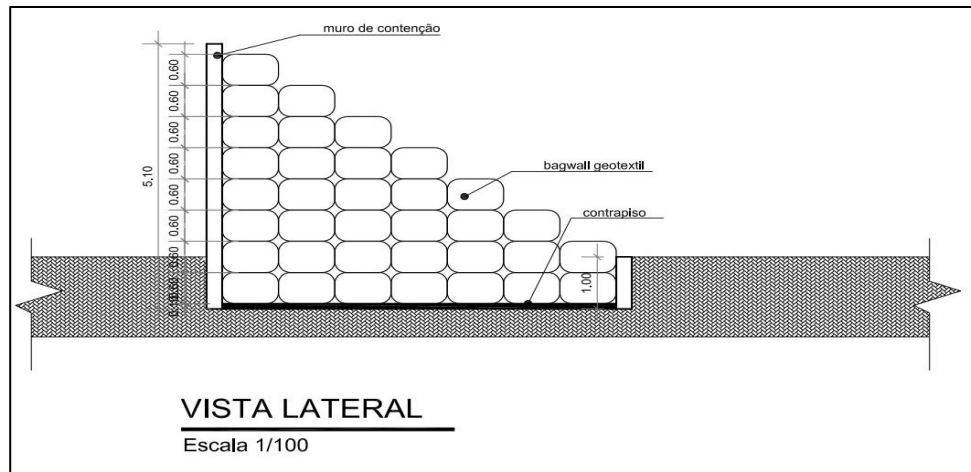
Vista lateral do projeto de intervenção de Bagwall
